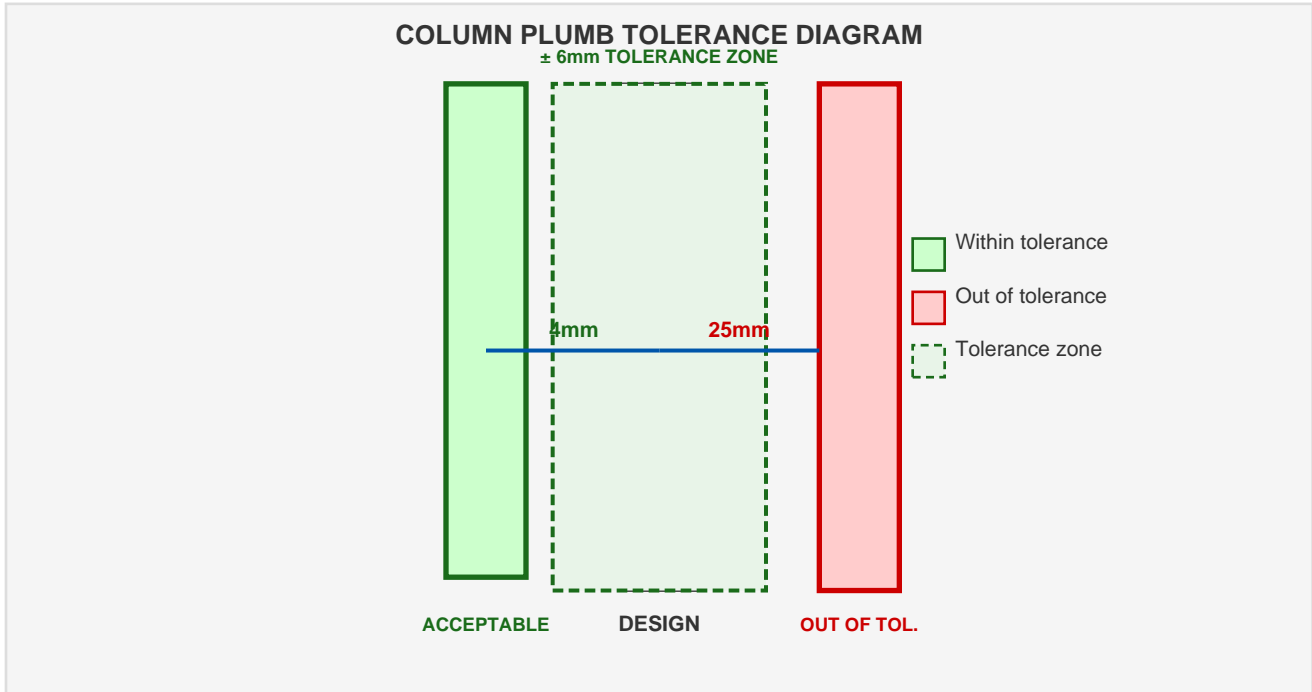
Tolerancia de plomada de columna — columna izquierda (4mm) aceptable, columna derecha (25mm) fuera de tolerancia
